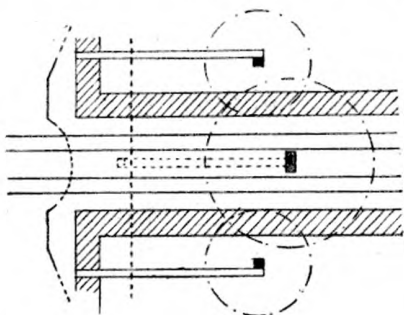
Dispositif de démolition partielle d'un tunnel.
